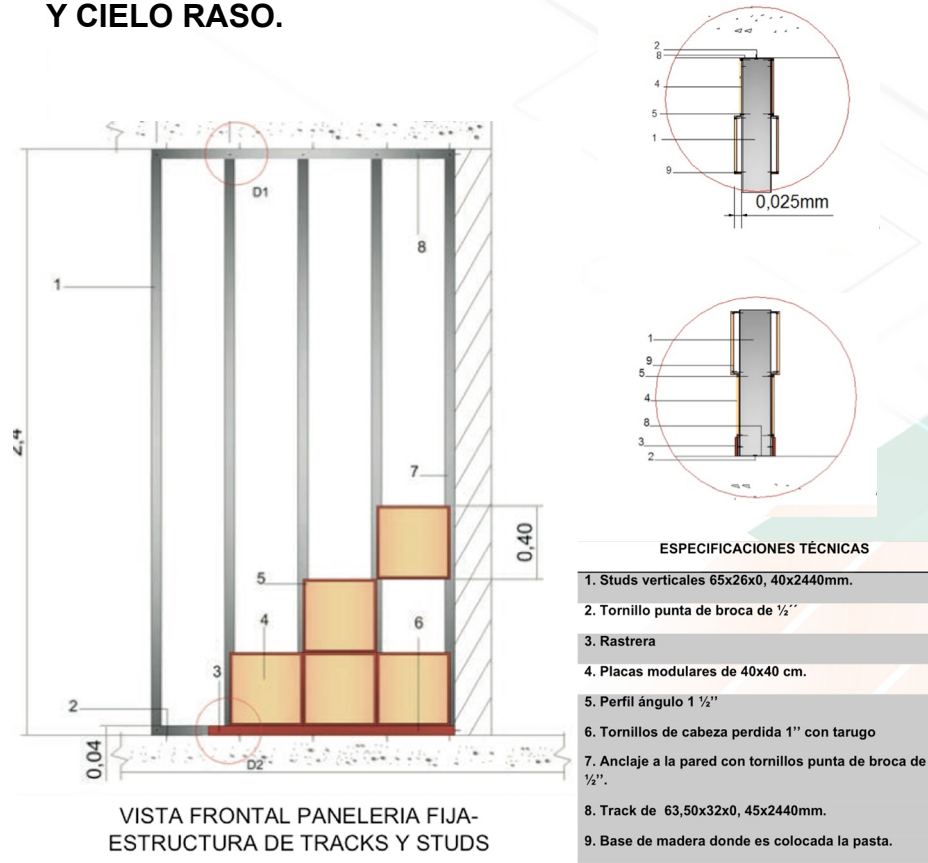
Detalle constructivo. Danilo Barrera 2014.
